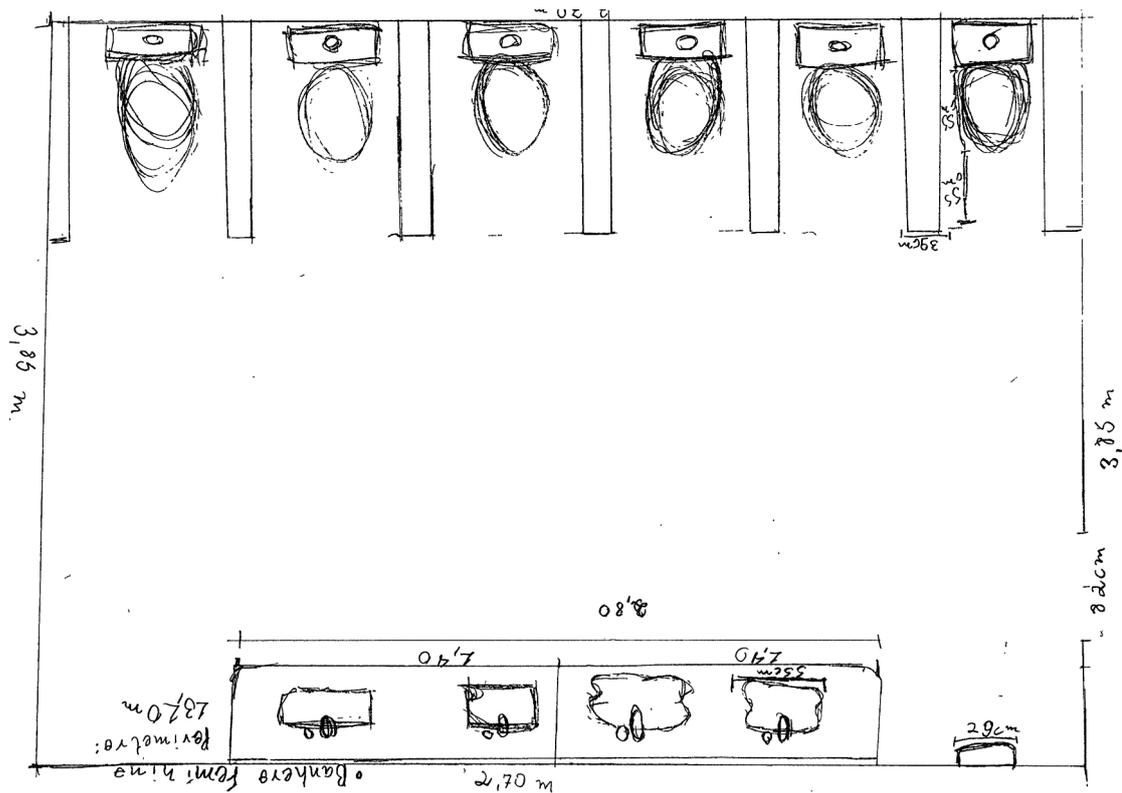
Atividade: planta baixa (6º Ano) - Acervo da autora
